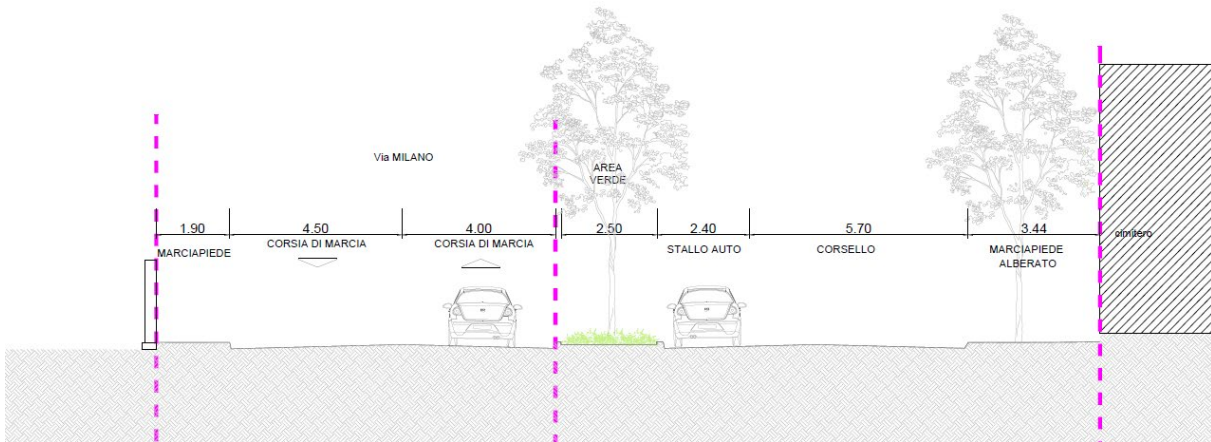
Sezione Via Milano - Piazza del cimitero SDF
